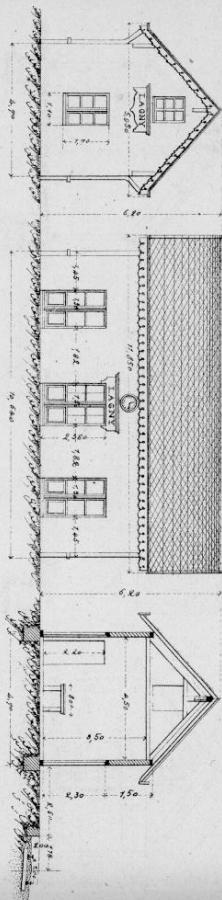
Plan. Coupe c.d à 0,01 p<sup>2</sup>/m.
